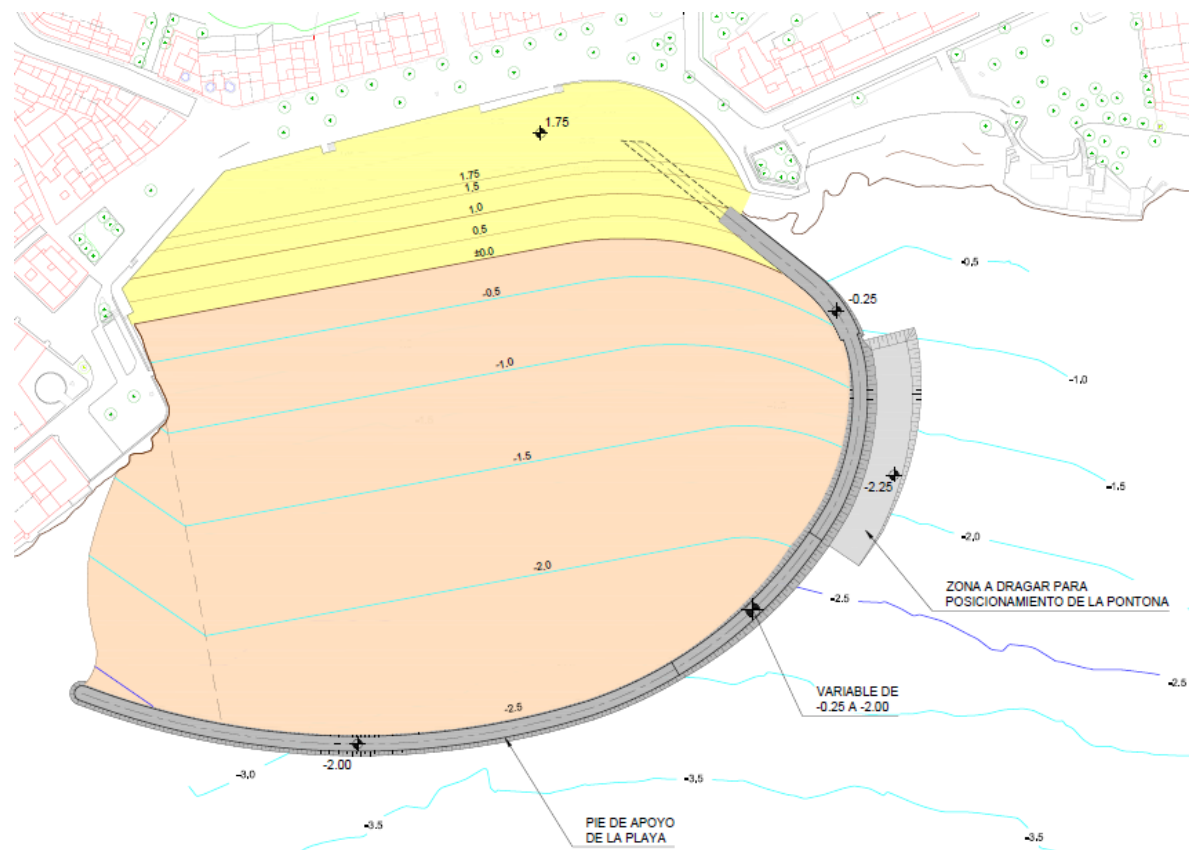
Planta de la Alternativa finalmente escogida (Fuente: elaboración propia)
